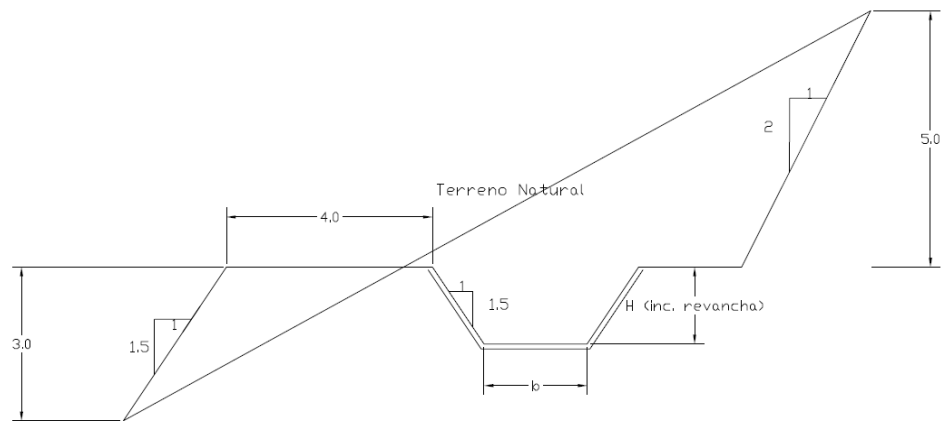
Corte tipo canal trapecial. Dimensiones en m.
